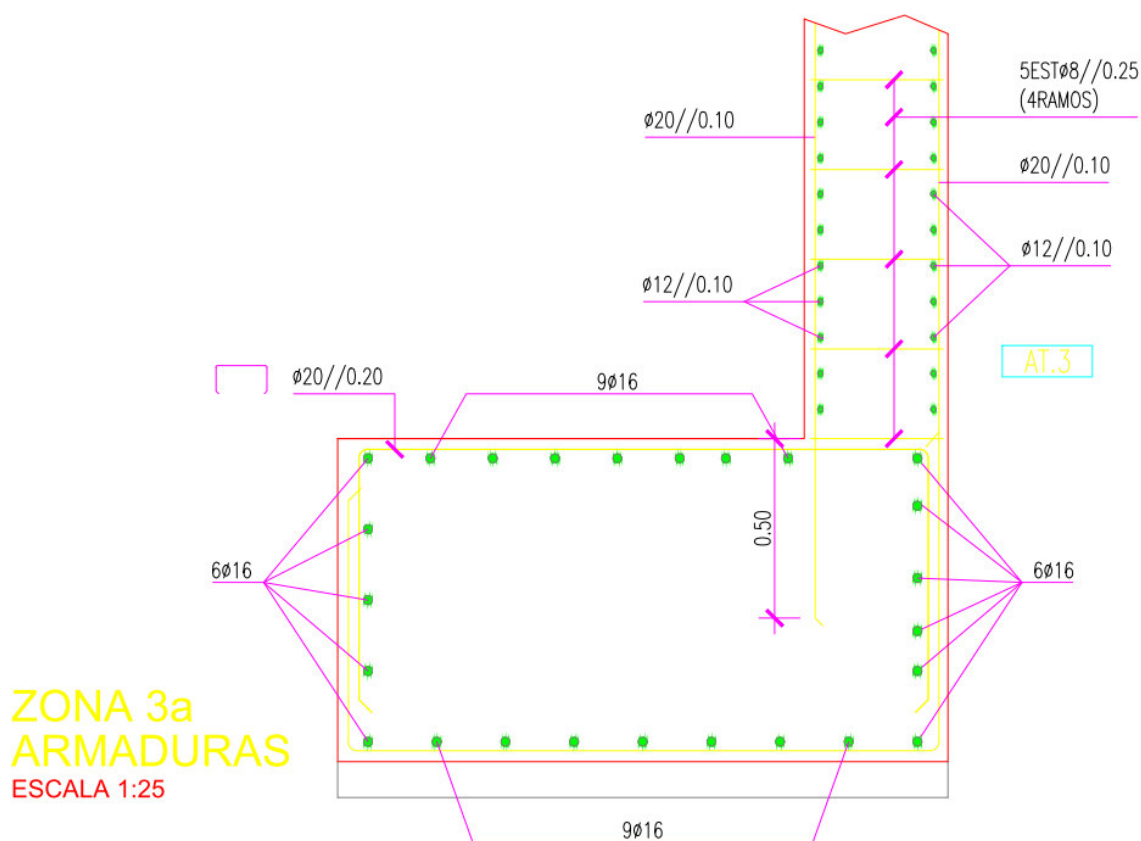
Armadura alterada da sapata do muro de Berlim. [Fonte: Peças Desenhadas, projeto ECP]
